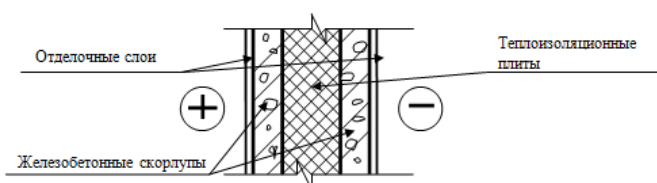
Конструкция навесной панели с двумя железобетонными скорлупами и плитным утеплителем между ними
